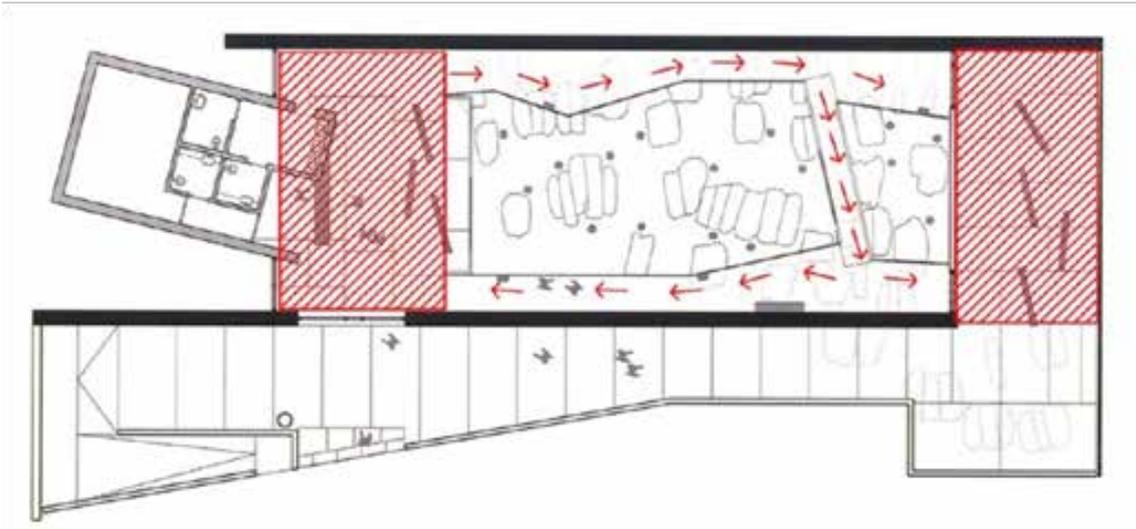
Pianta delle Necropoli di Pill' E Mata.
